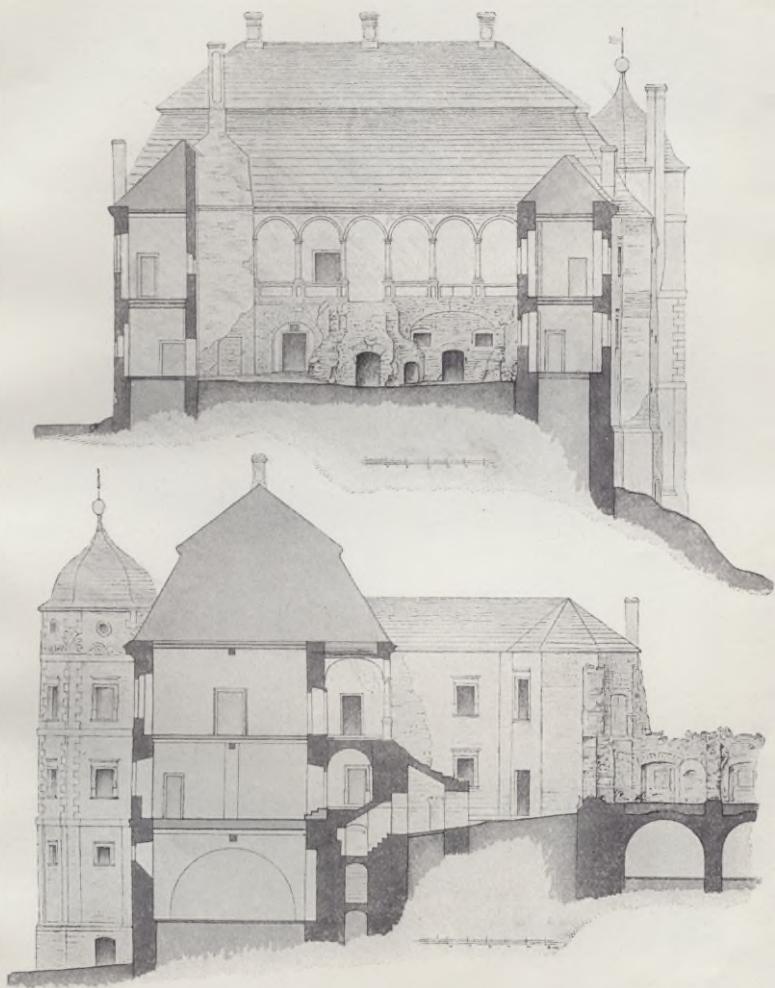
ZAMEK GOŁUCHOWSKI, PRZEKROJE (przed restauracją).
